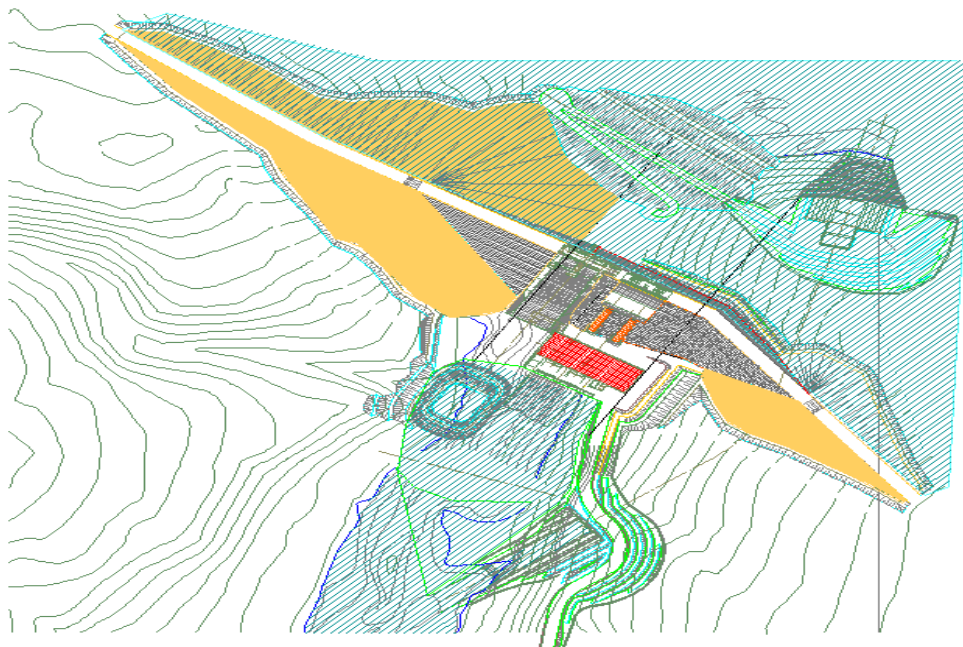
Etapa 4 – a) remoção da ensecadeira de montante; b) fechamento do túnel de desvio; c) enchimento do lago; d) término da barragem de concreto; e) término da montagem dos equipamentos; f) comissionamento e geração comercial.
